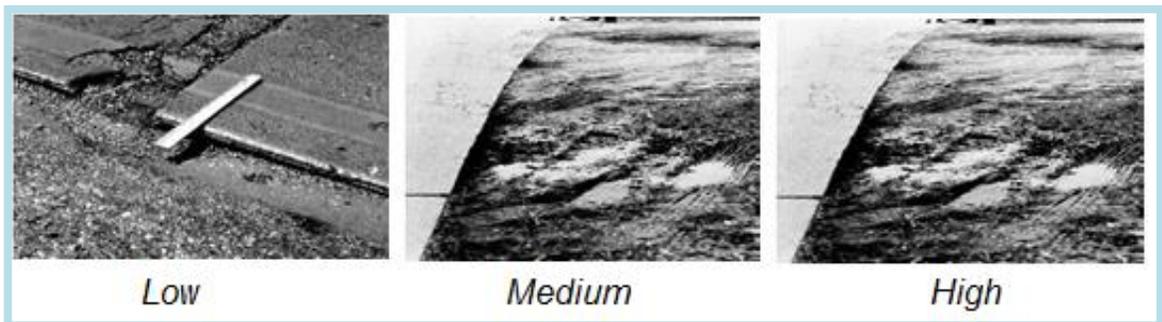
Tingkat Pengisi Sambungan (*Joint seal damage*)
